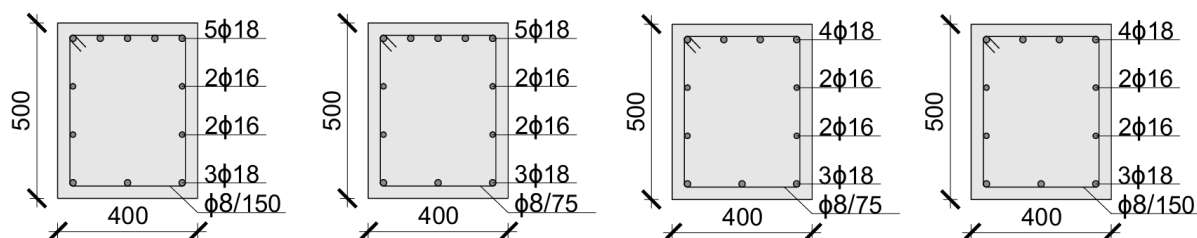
Sezioni trasversali tipo delle travi migliorate con dettaglio dell'armatura longitudinale e trasversale – sezioni 2', 3', 4' e 5.
